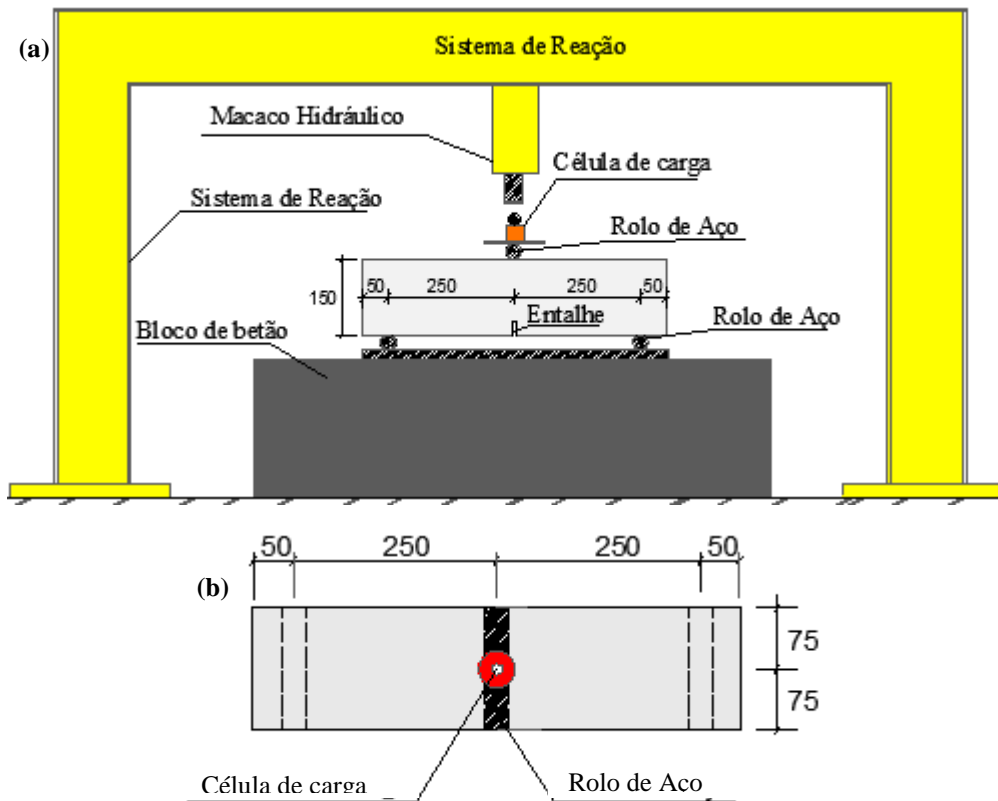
Esquema dos ensaios das vigas, (a) vista geral da viga e do pórtico de reação e (b) vista em planta da viga (desenho sem escala e dimensões em mm).
